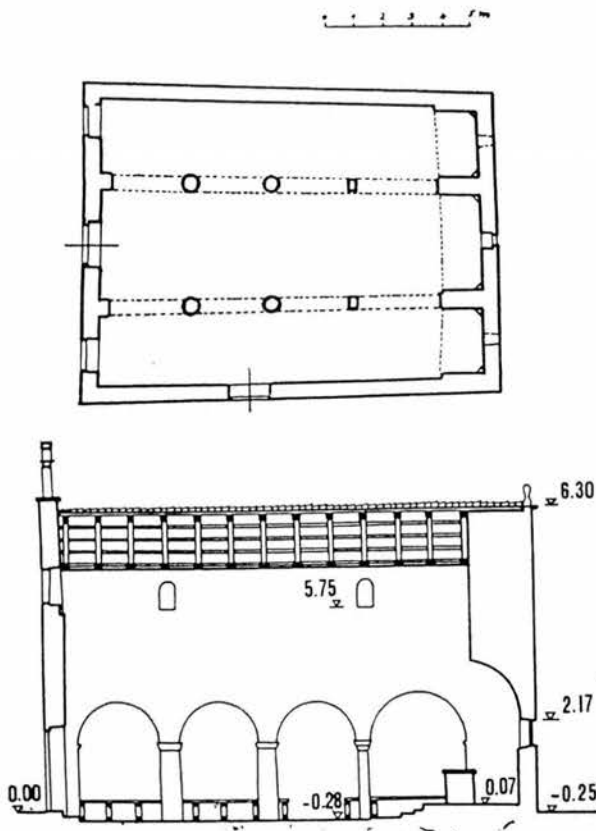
Pianta e sezione della chiesa di Santa Fosca
